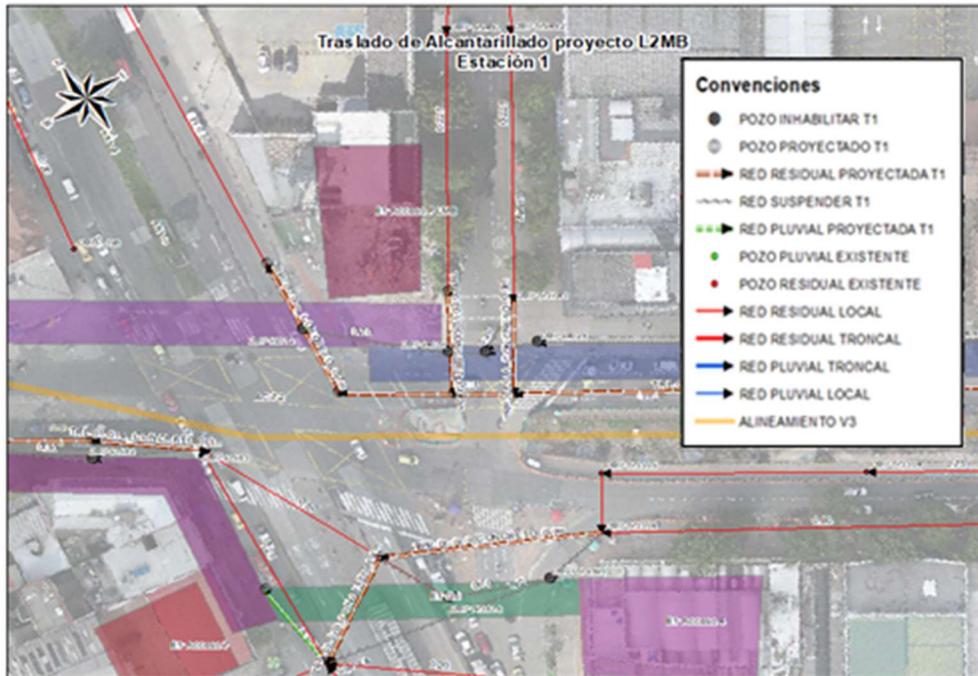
Traslado redes de alcantarillado Estación 1 Calle 72 con Av Caracas costado Sur
